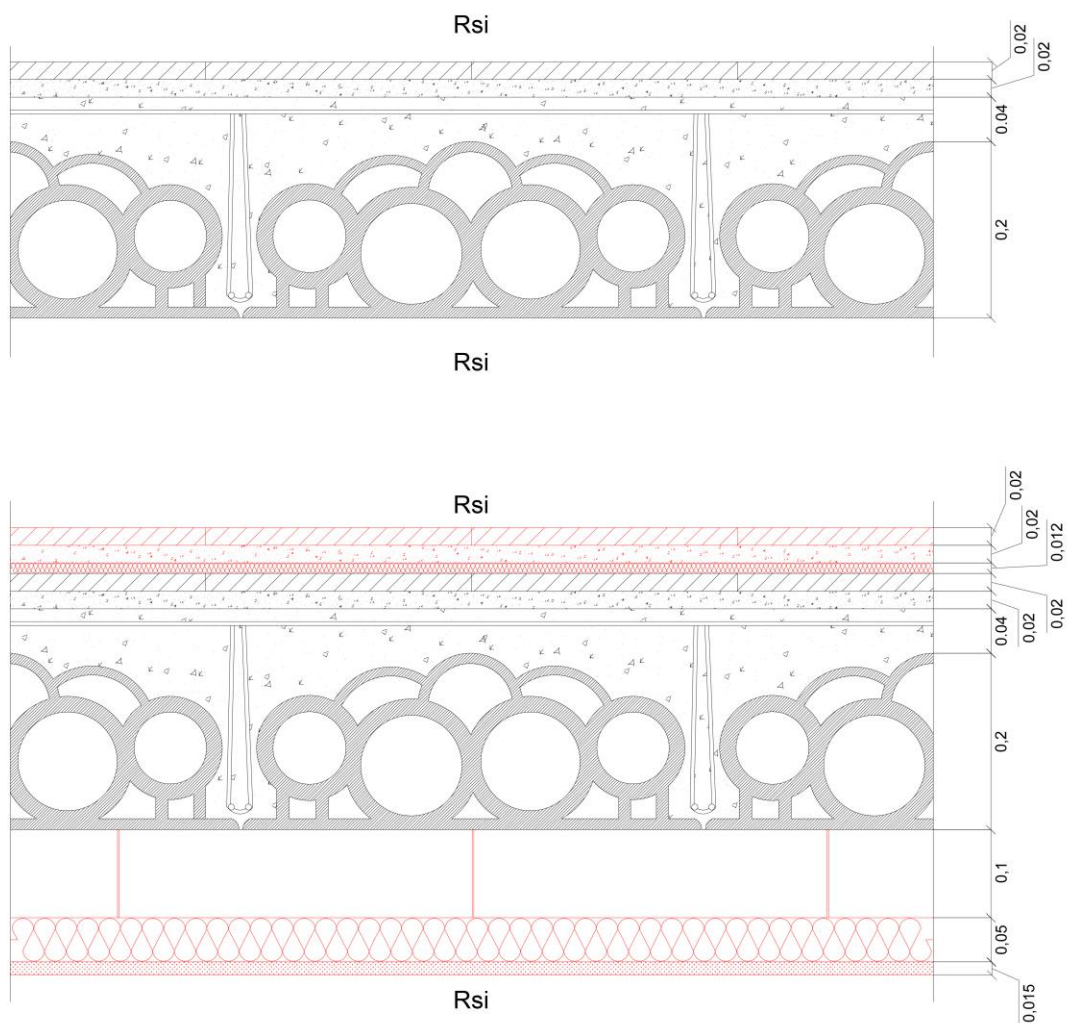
Detalle constructivo de los elementos horizontales de separación entre recintos (forjados) tras el análisis y las propuestas.
